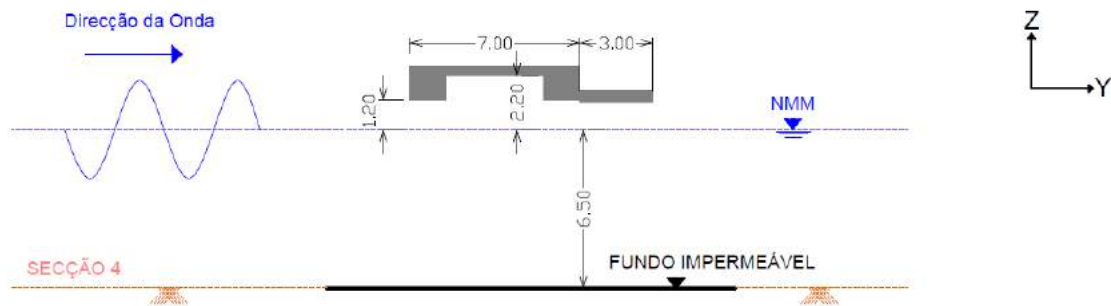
Secção transversal 4 da Ponte-Cais e respectivas dimensões em metros.
